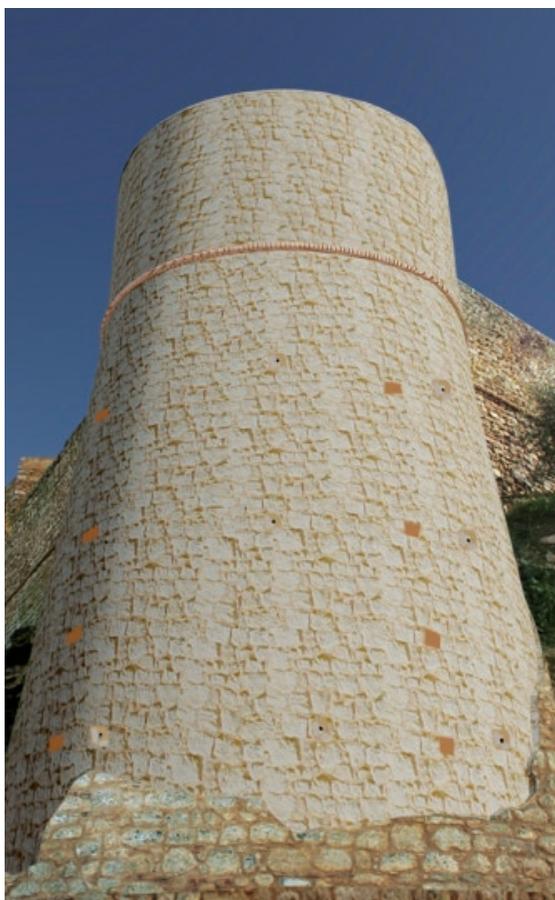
Vista prospettica ricavata dal modello tridimensionale.
